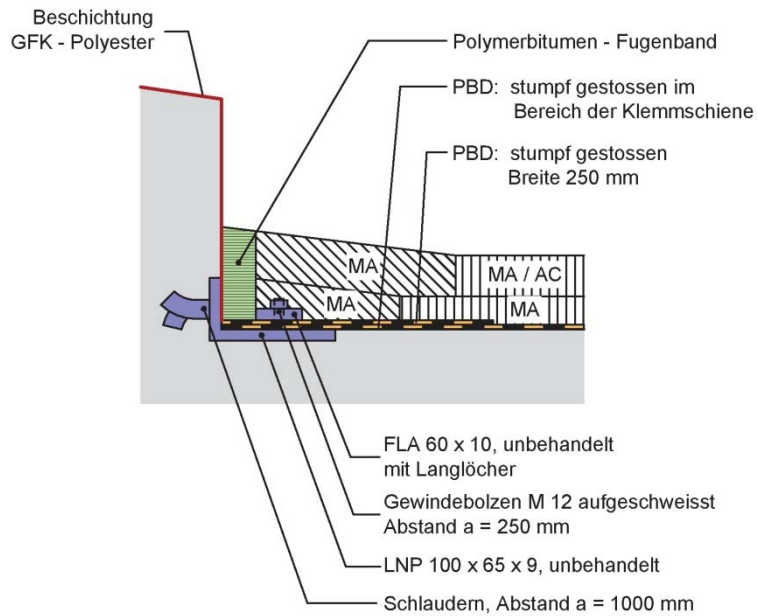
Anschluss Stahlwinkel mit aufgeschraubter Klemmschiene, Beton beschichtet
